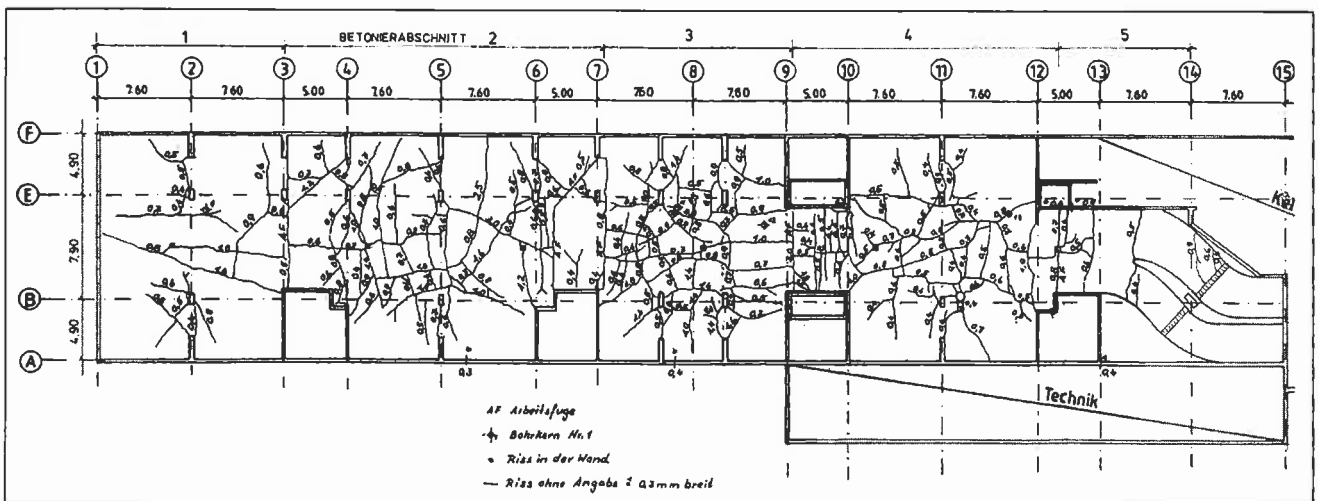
Grundriss einer gerissenen Bodenplatte
